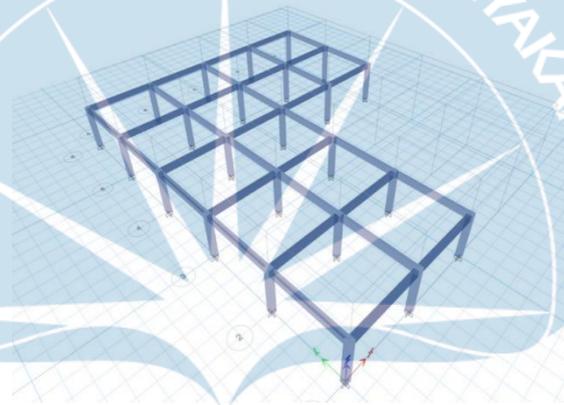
Bentuk 3D bangunan *Workshop
